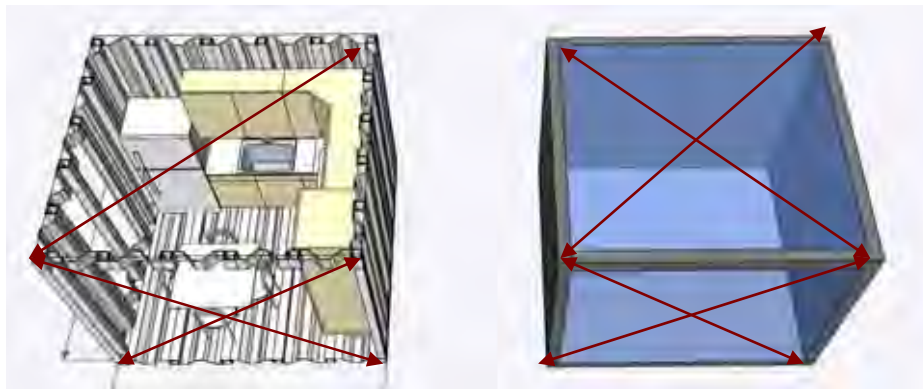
Elementos de refuerzo. Fuente: elaboración propia 2008
